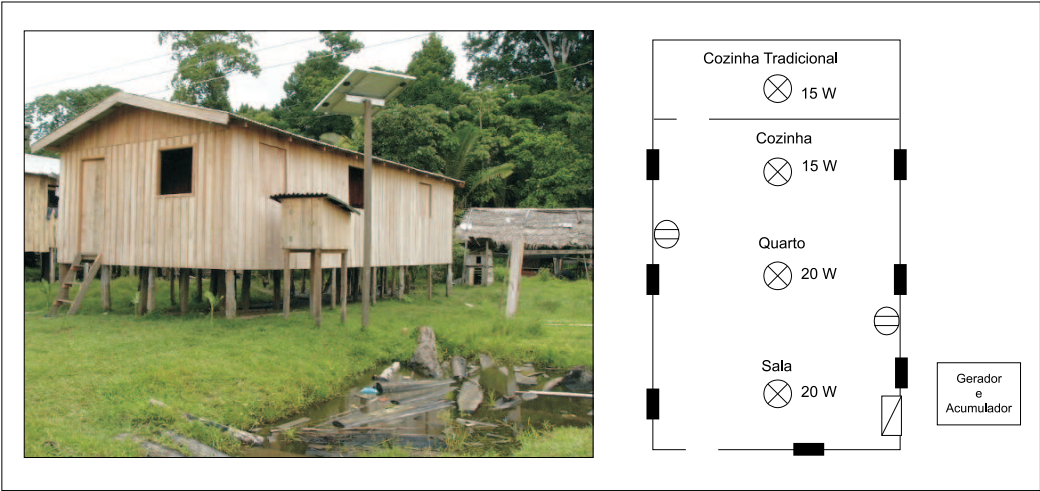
Vista externa do SFD7 e planta aproximada do domicílio.
